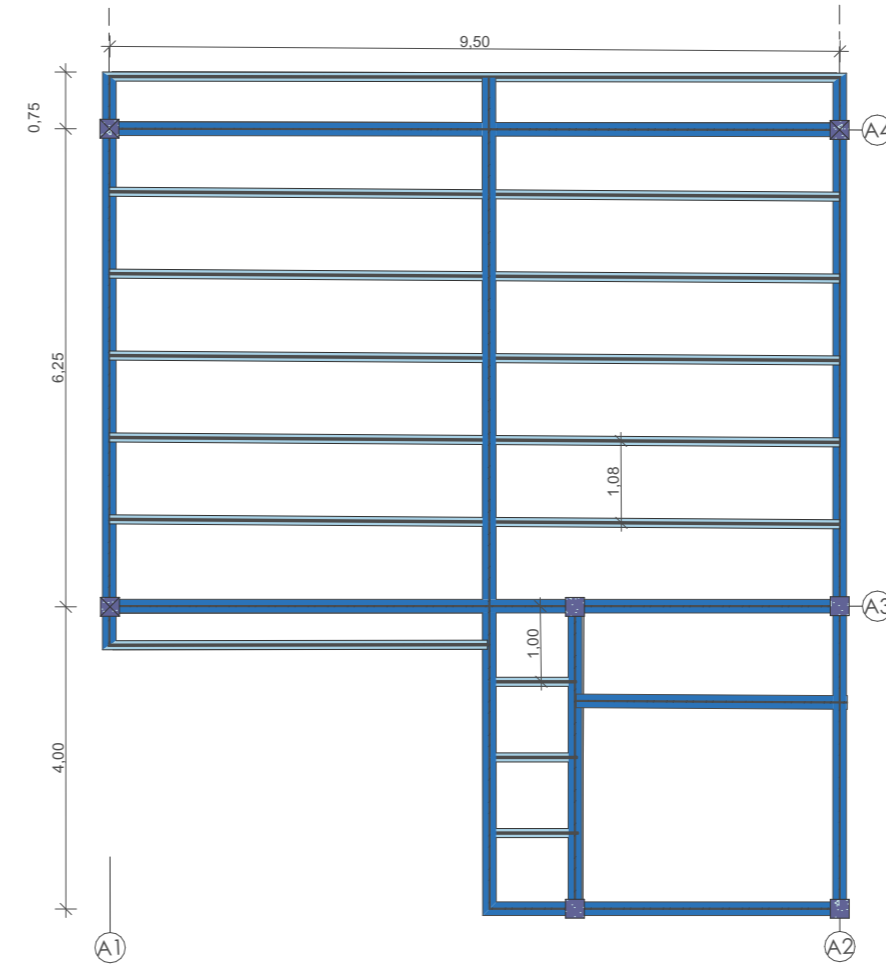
Planta de estructura del Bloque A Elaboración propia (2026). Escala 1:100
